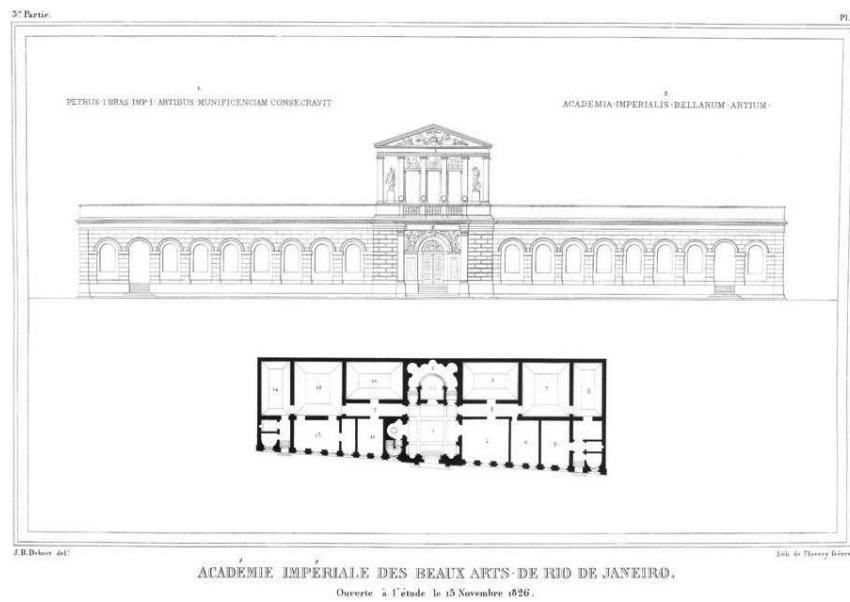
Planta e elevação do edifício da Academia Imperial de Belas-Artes do Rio de Janeiro (esq.).
